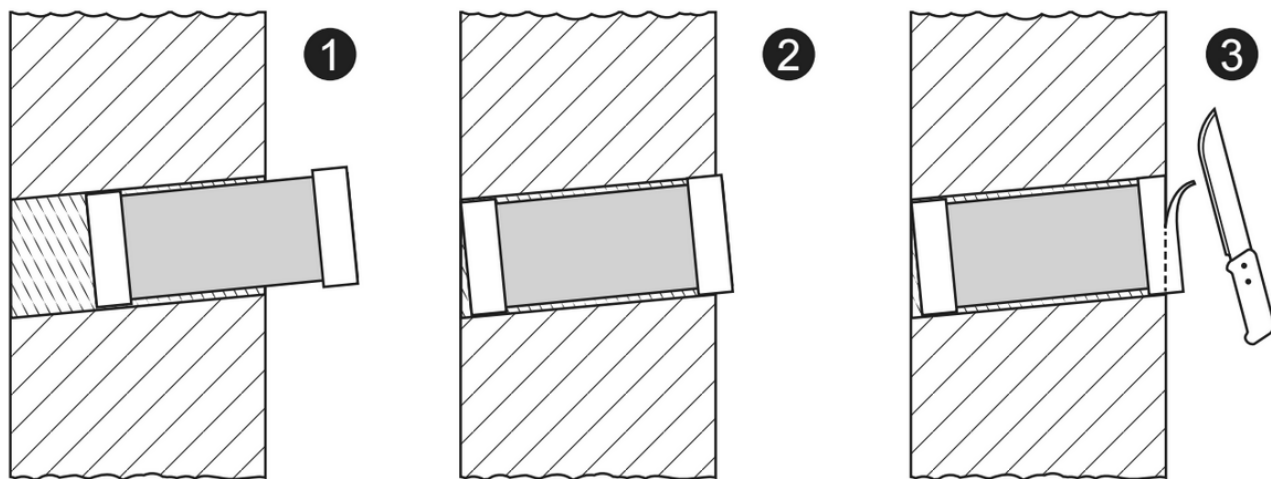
Установка вентиляционной трубы с вентиляционной решеткой в канал воздуховода.
